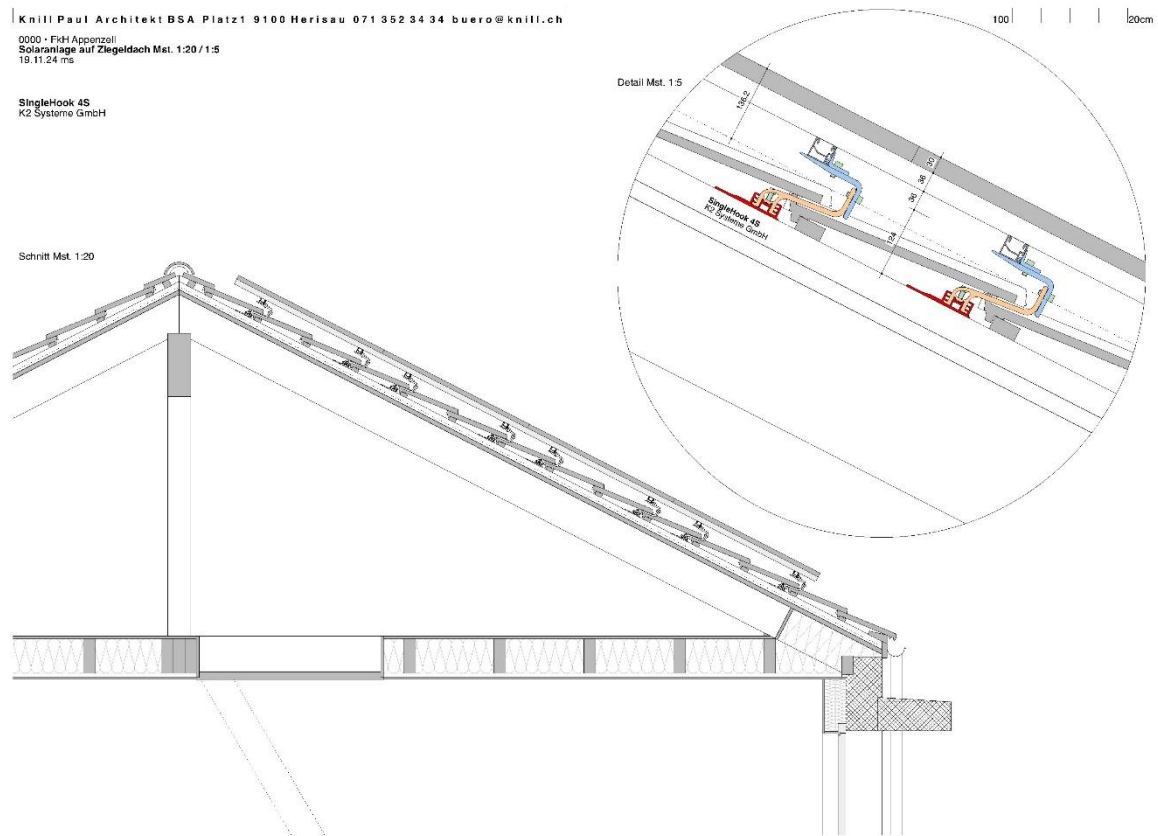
Konstruktionsdetail Aufdachanlage: Mit einer optimierten Montage lässt sich eine Aufdachanlage auf eine Aufbauhöhe von unter 14 cm reduzieren (Plan: Paul Knill, Architekt BSA, 2024).
